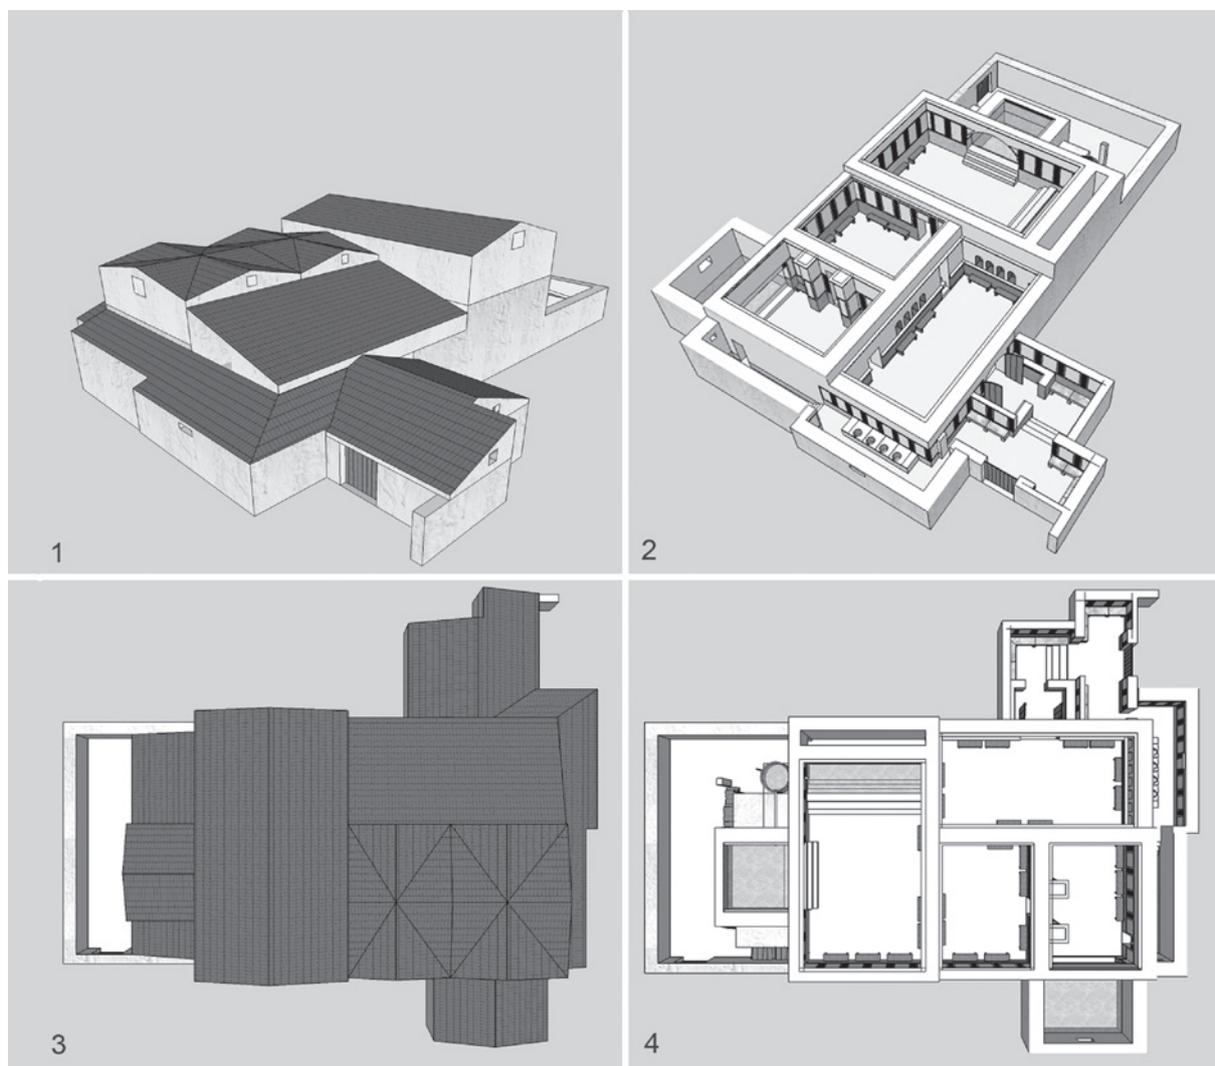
Reconstrucción 3D de planta y cubierta de las termas de Los Bañales (V. García-Entero y R. M^o Oliveros Díaz).
